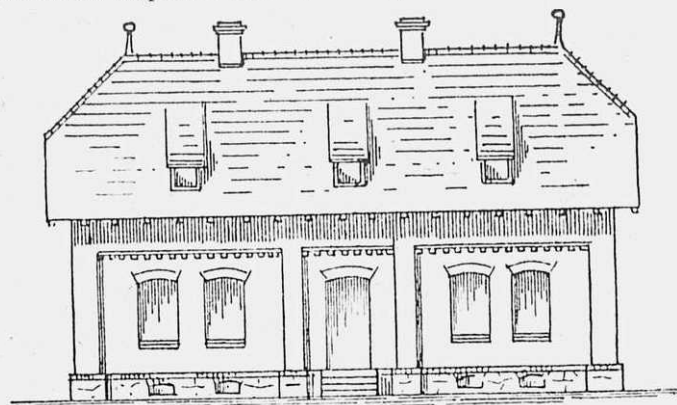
Хозяйскій домъ на маломъ хуторѣ (изъ кирпича, бетона и самана). Фасадъ.
